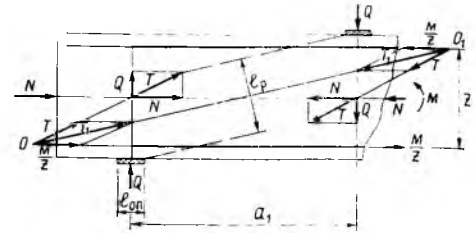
Расчетная схема железобетонных элементов при поперечном изгибе продольными сжимающими силами высокого уровня
